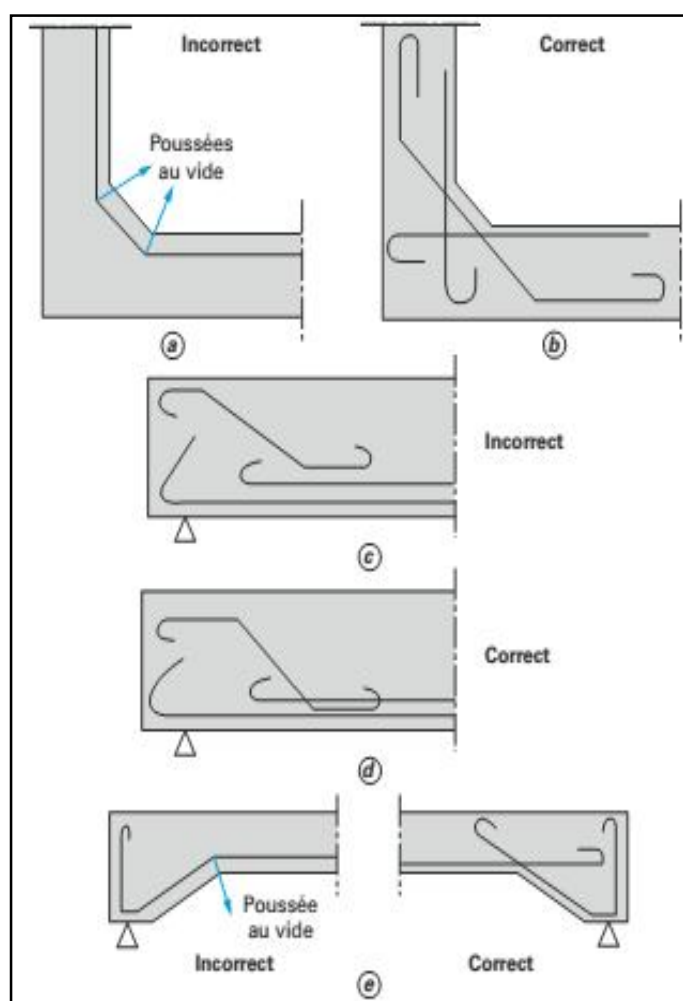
Solutions de ferrailage à Poussées au vide.
